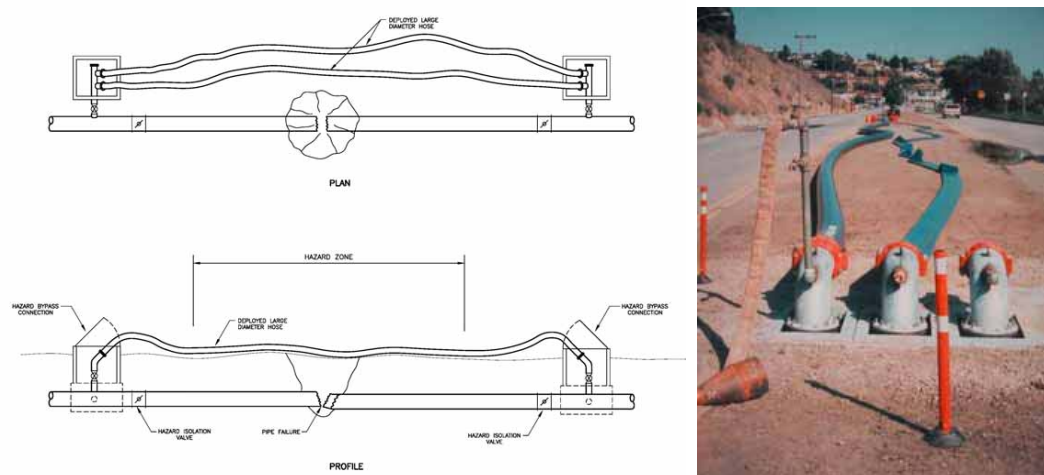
Anordnen von Sperrventilen und Einsatz von Notleitungen zur Umgehung einer Schadenstelle am Beispiel einer Wasserversorgungsleitung (ALA 2005), links: Grundriss oben, Aufriss unten
